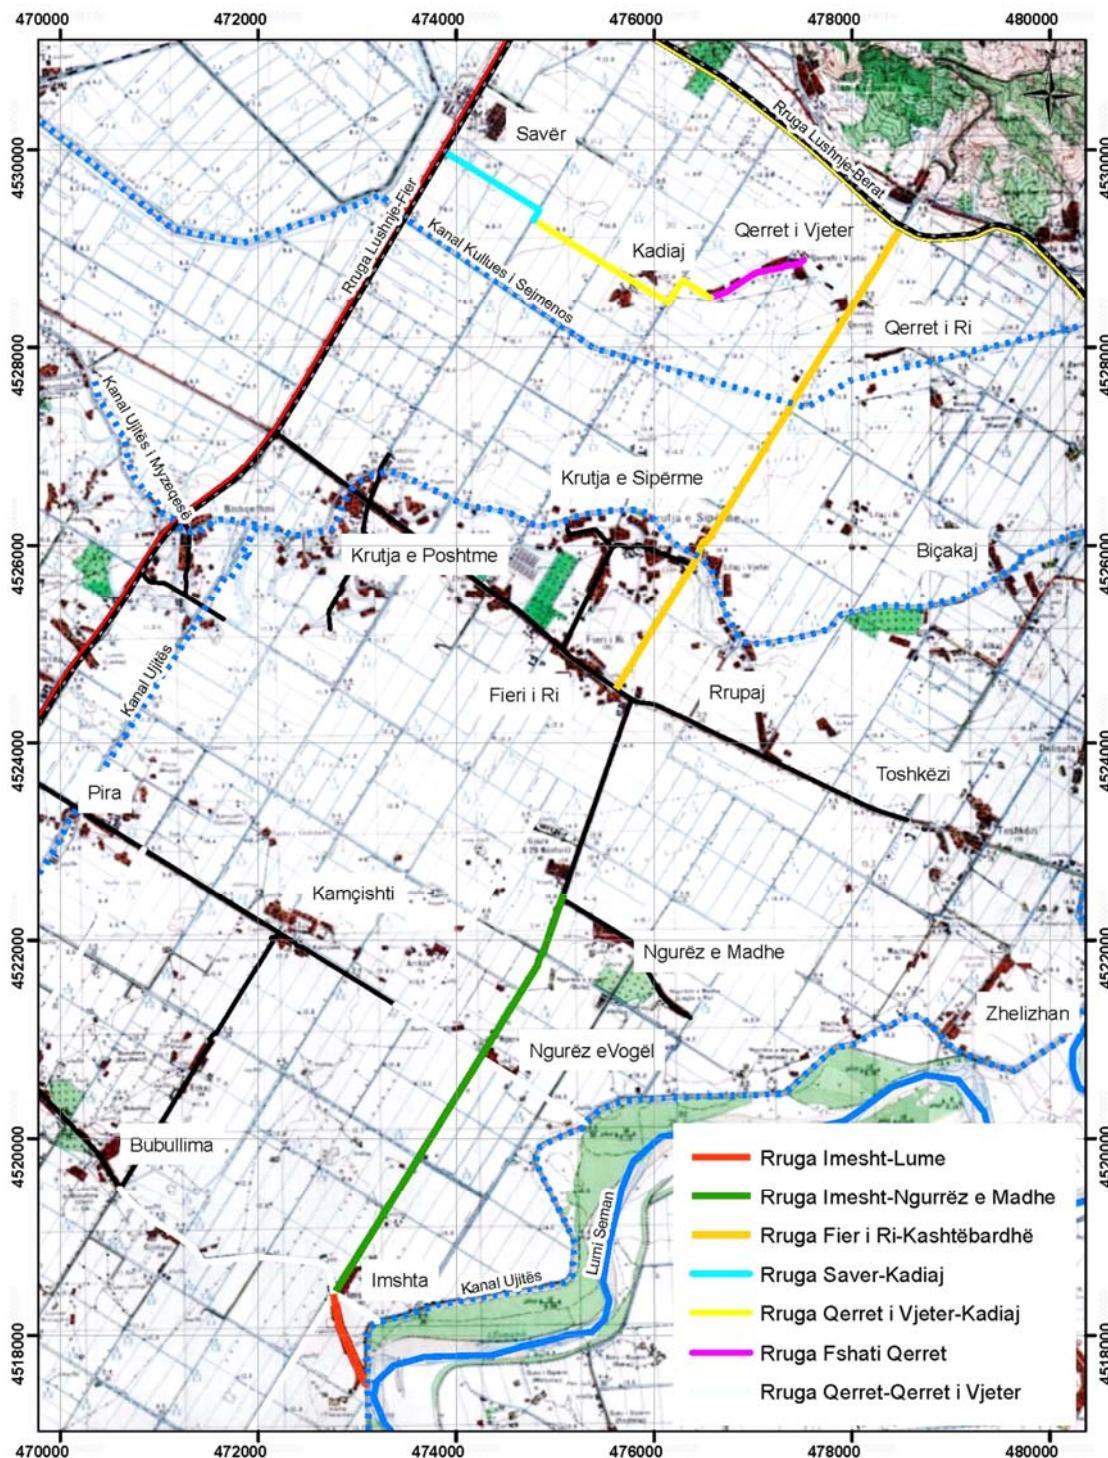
Planvendosja e Rrugëve që do të Ndërtohen
